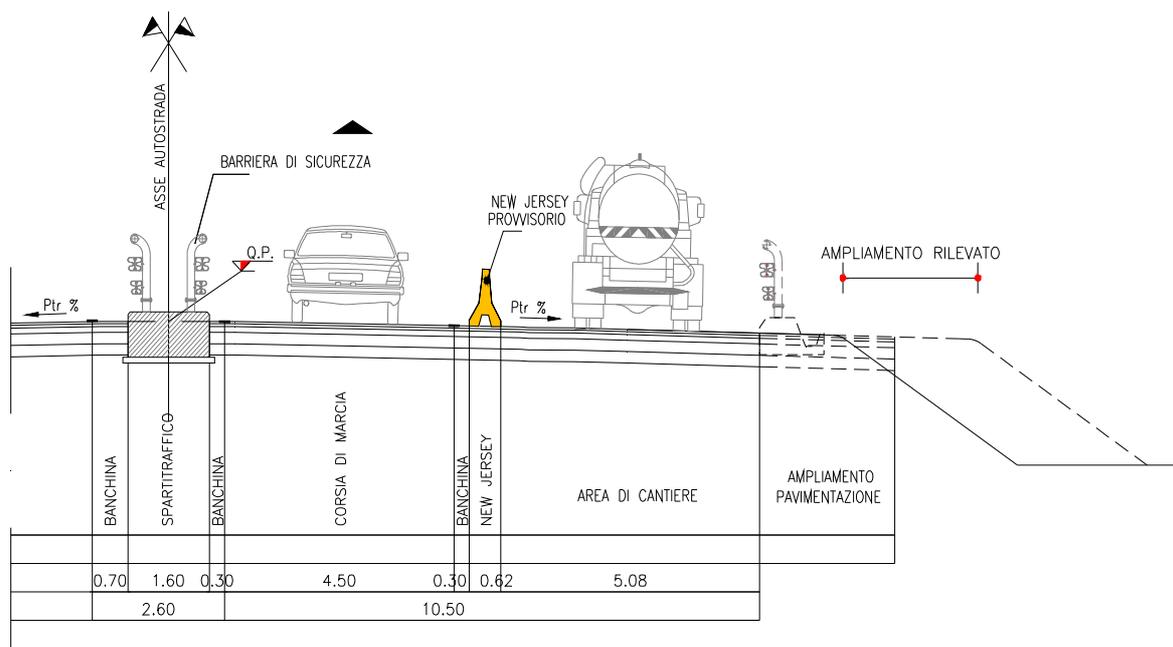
Sezione tipo di cantierizzazione della “A32”
